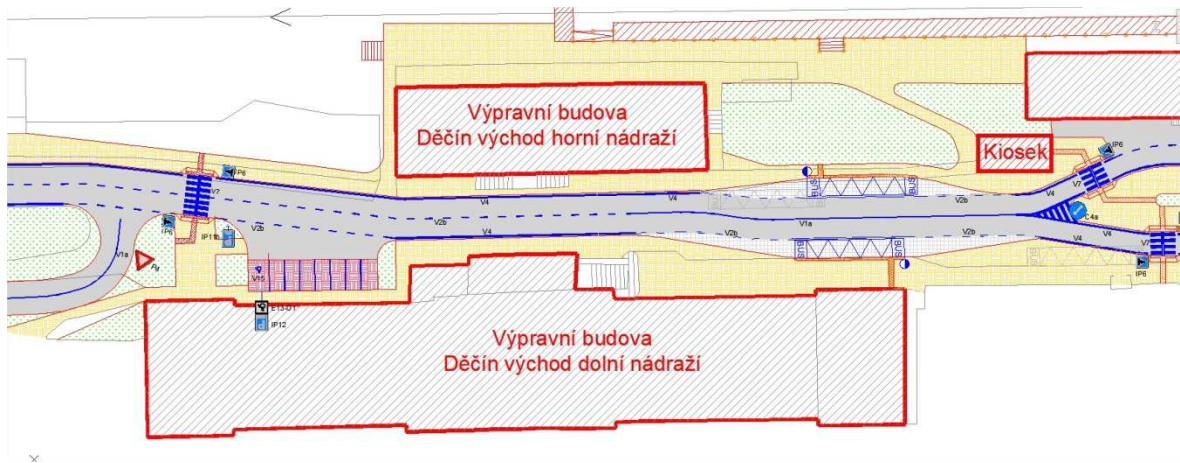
Úprava prostoru přednádraží varianta 1. (původní návrh)
